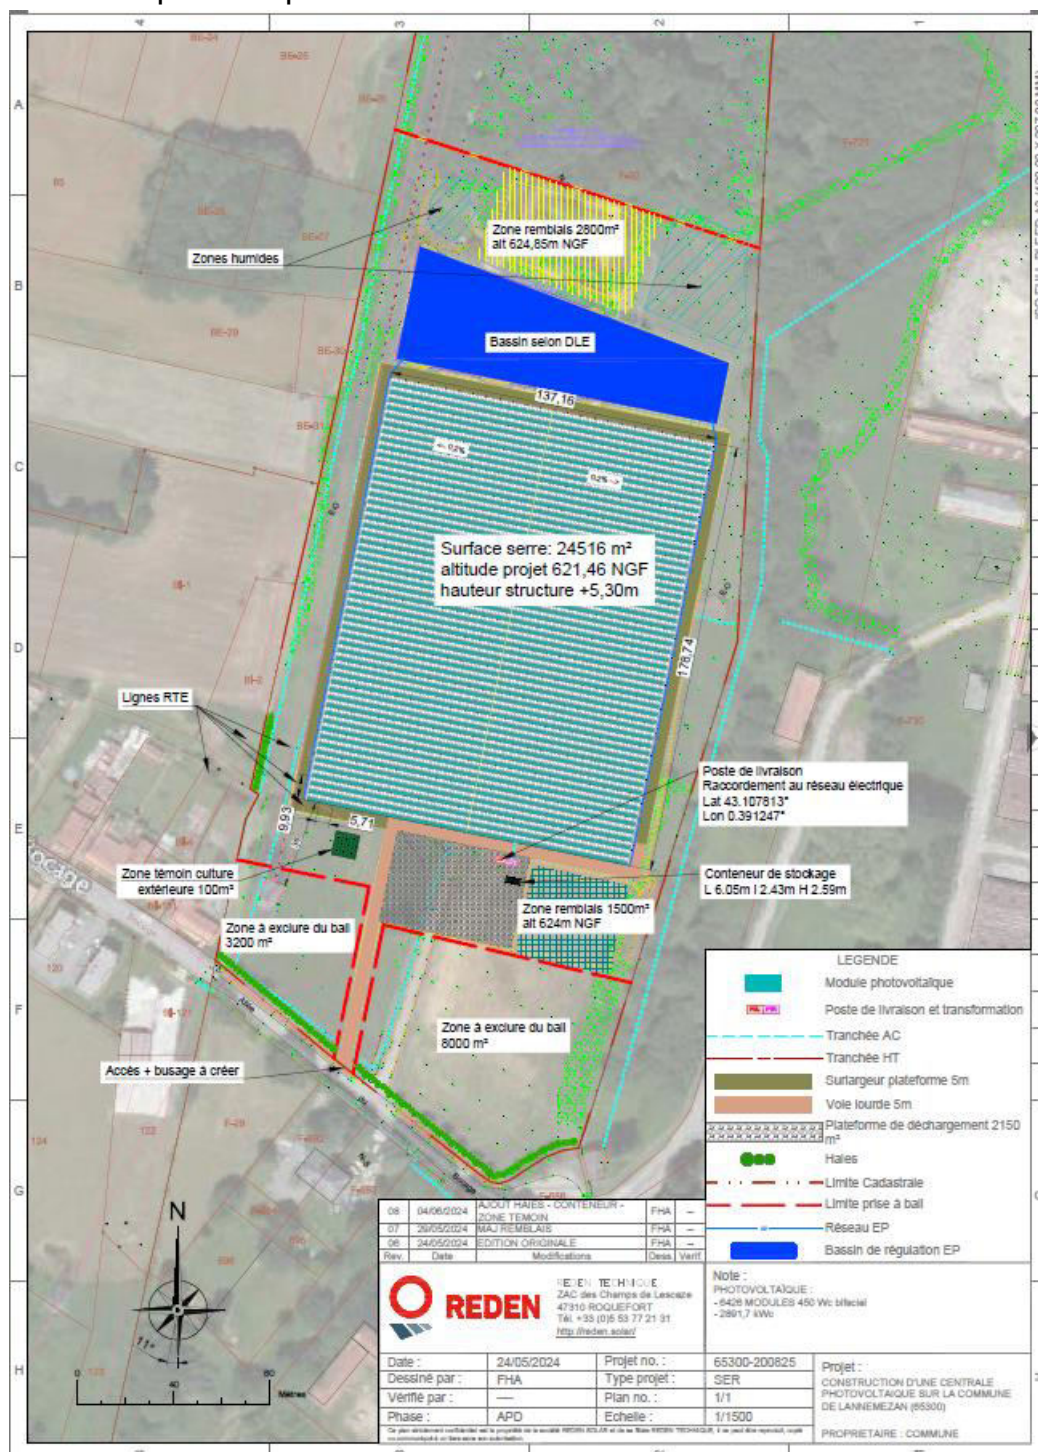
Implantation du projet : plan de la serre. Source : REDEN, 2024.
